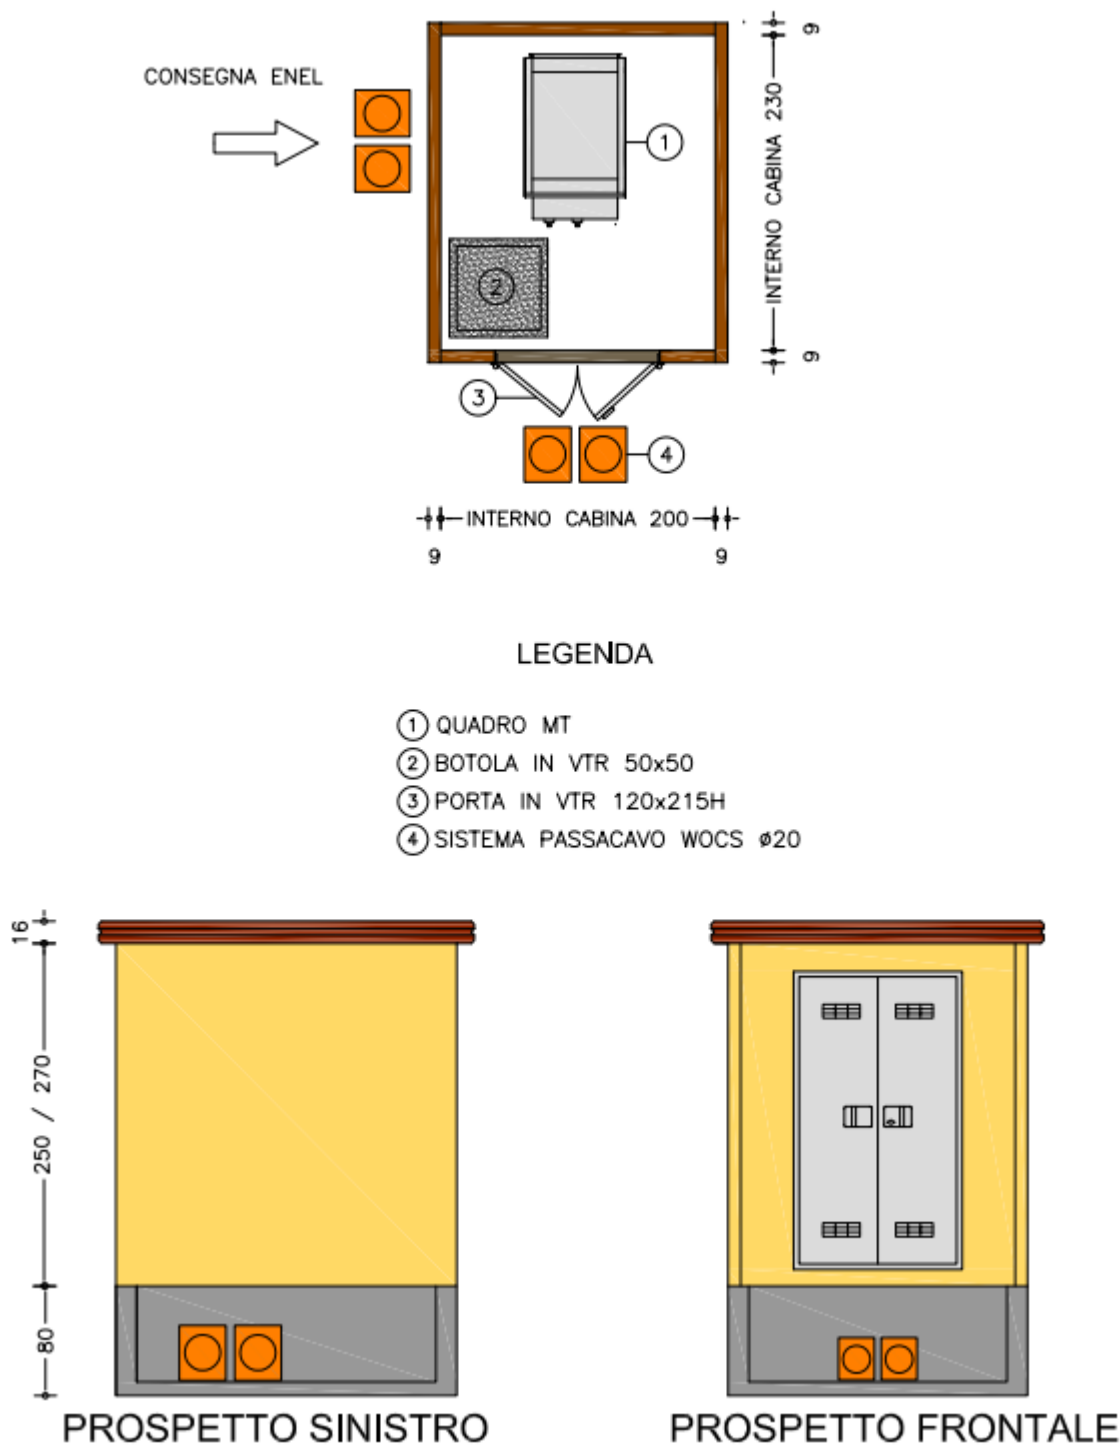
prospetto e pianta di una cabina MT di utenza (fonte Ferrari Cabine)
